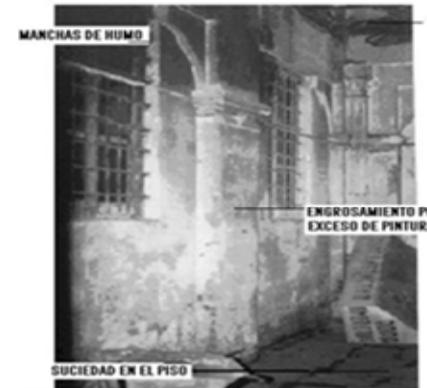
COLUMNAS INTERIORES DEL ZAGUAN
